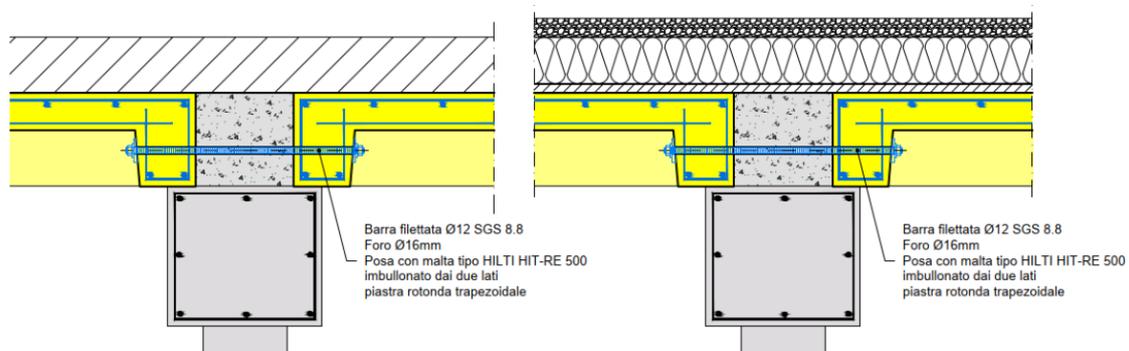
Blocco aule est/ovest, dettagli tasselli d'ancoraggio: (sinistra) collegamento sopra PT; (destra) collegamento sopra P1 (tetto).
